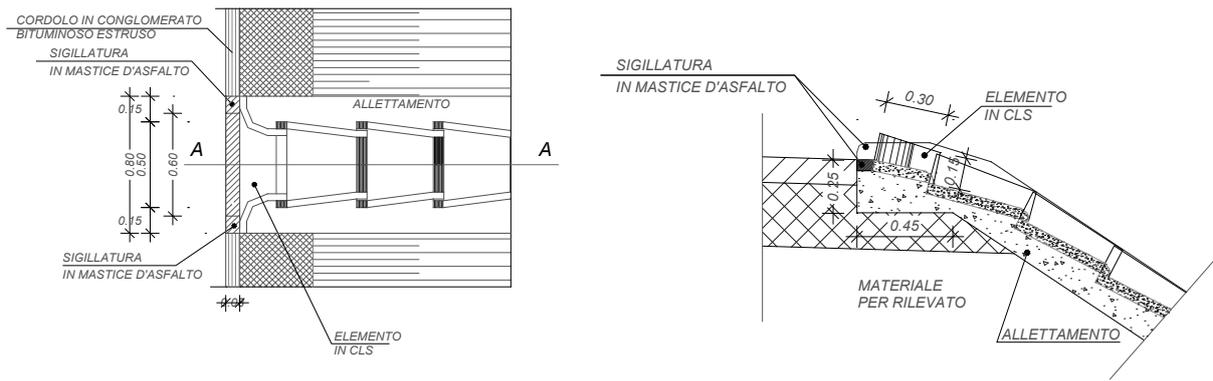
Dettaglio in pianta e sezione testa embrici su piattaforma ferroviaria
